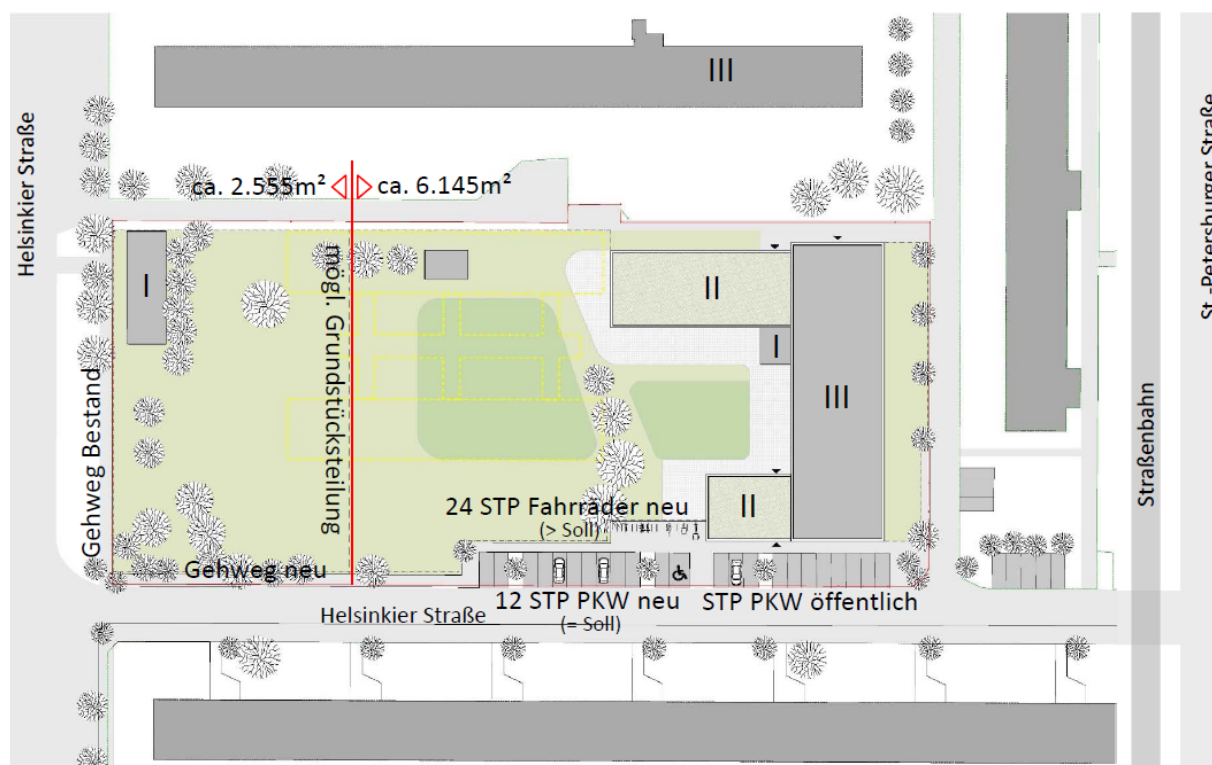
Entwurf Lageplan, Quelle: Matrix Architektur
